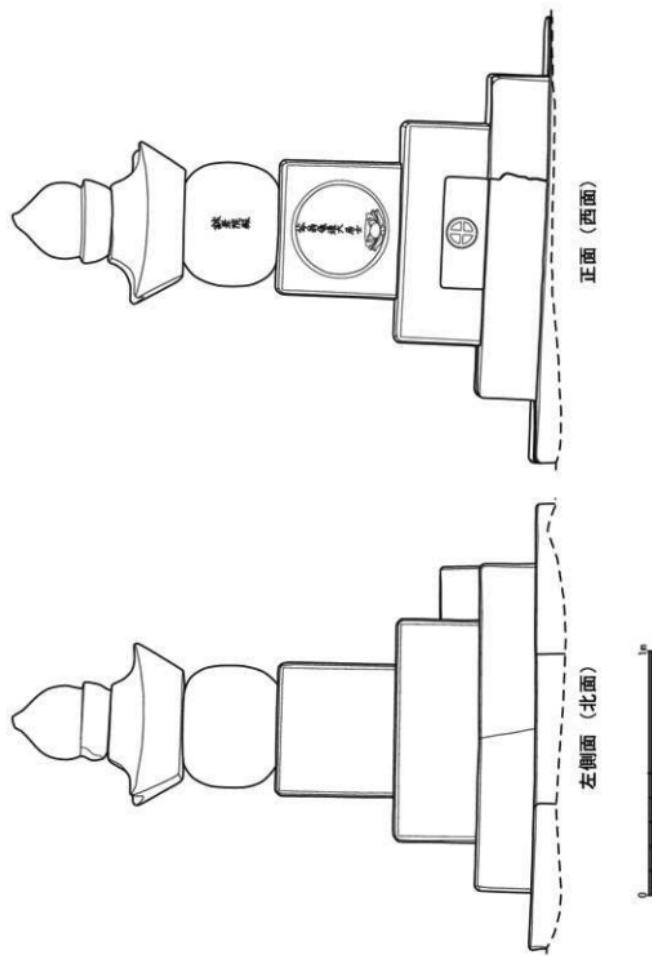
3号墓 4代当主岛津忠直墓石立面图 (S = 1/20)
